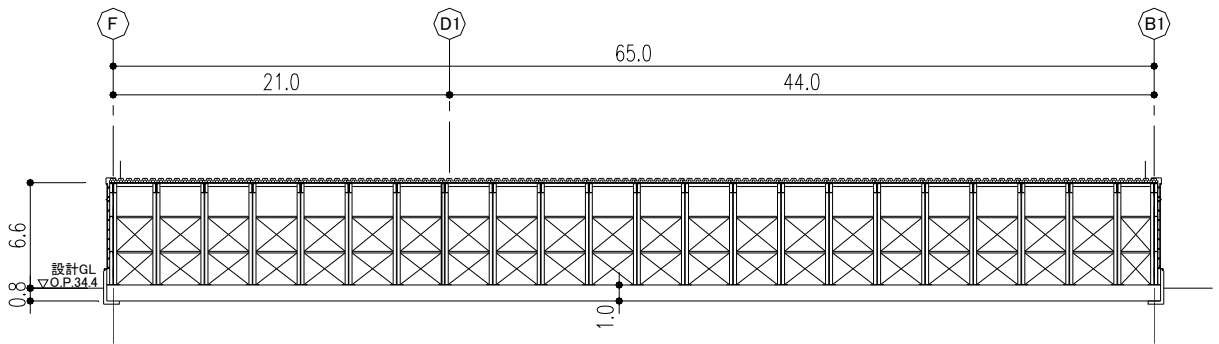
設備棟 B-B断面図 (EW方向) (単位:m)
